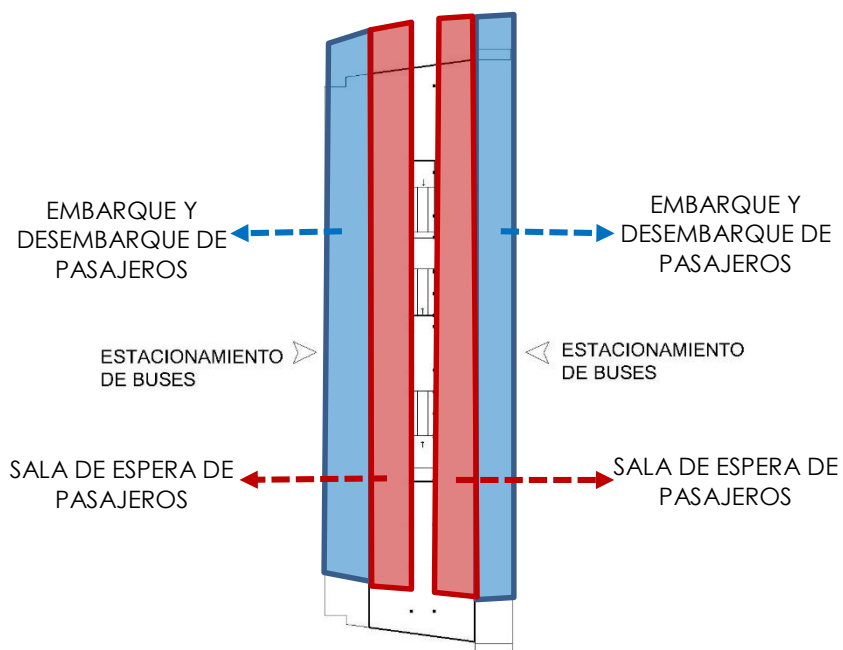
Vista en Planta de Semi Sótano de Terminal Terrestre Plaza Norte
